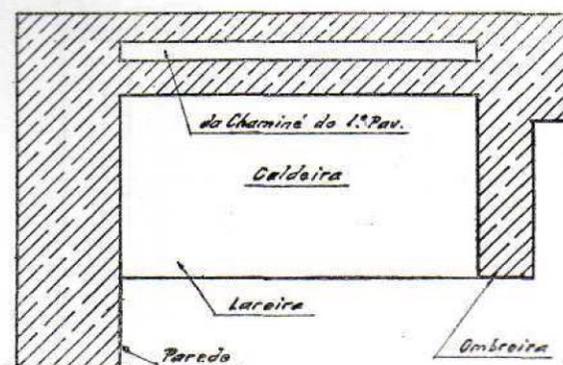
CHAMINÉ DE UM 2.º PAVIMENTO
